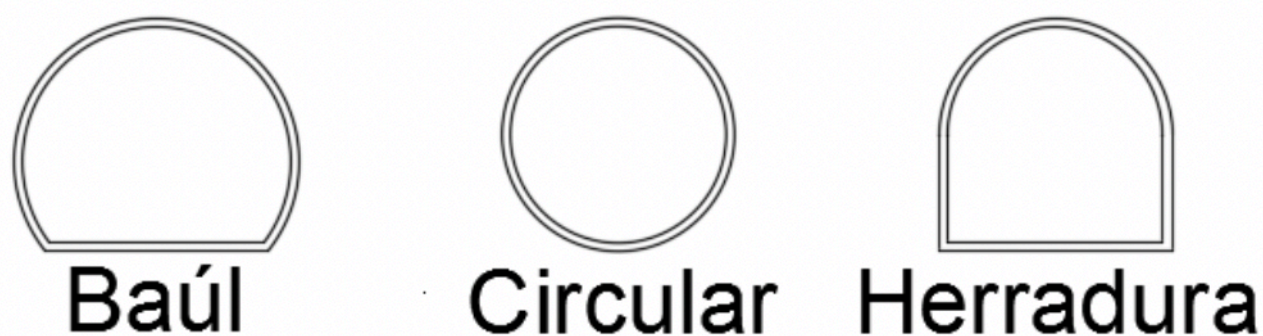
, Geometría típica de túneles, sección transversal de la excavación (Velásquez & Mucho, 2010).
